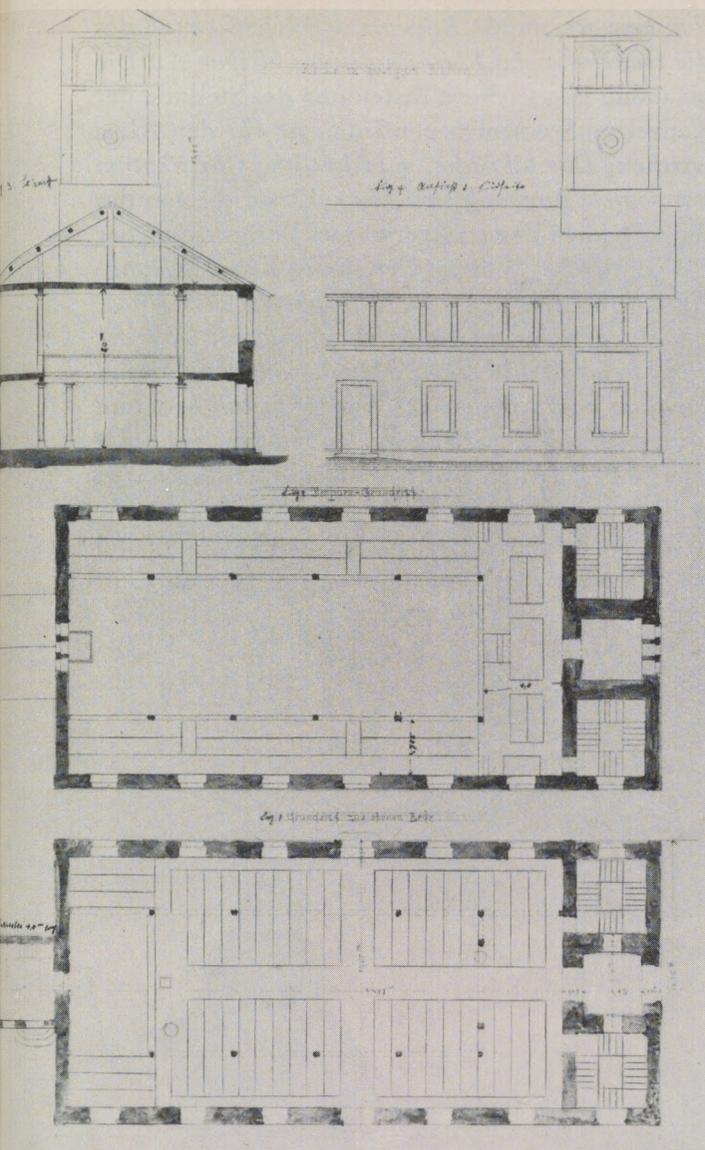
Grund- und Aufriß der Kirche in Esslingen-Sulzgries. Plan im Stadtarchiv Esslingen (aufgenommen 1898).
